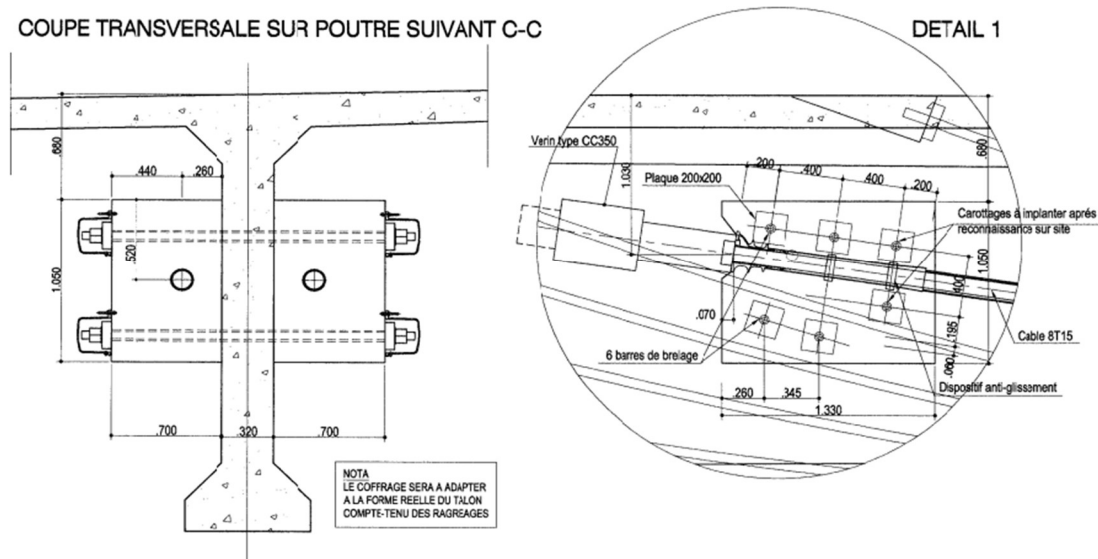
PLAN DE RENFORCEMENT ET DÉTAILS DU BLOCHET
